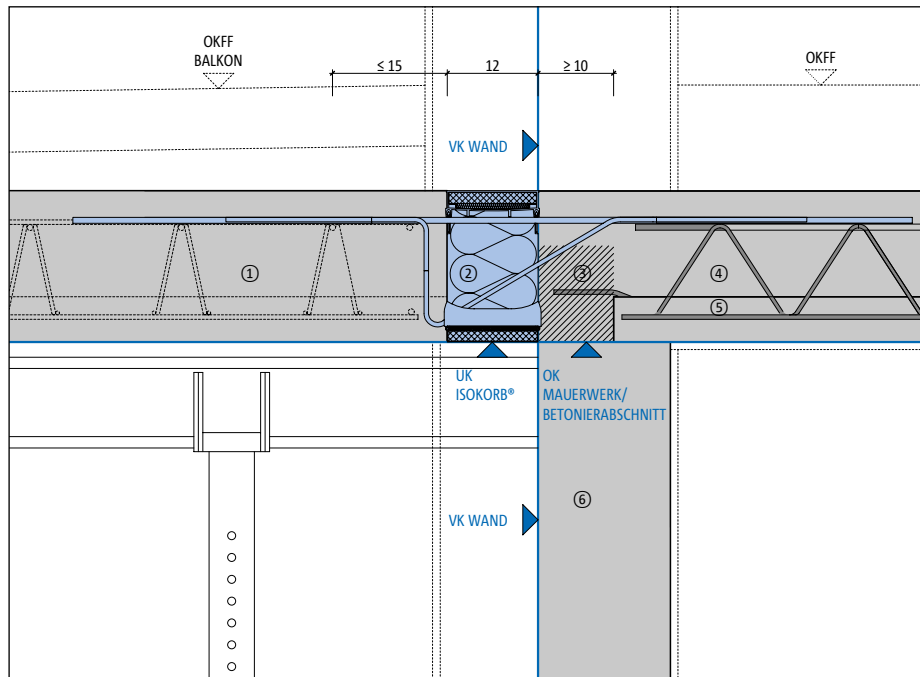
Neuer Balkonanschluss an bestehendem Stahlträger
